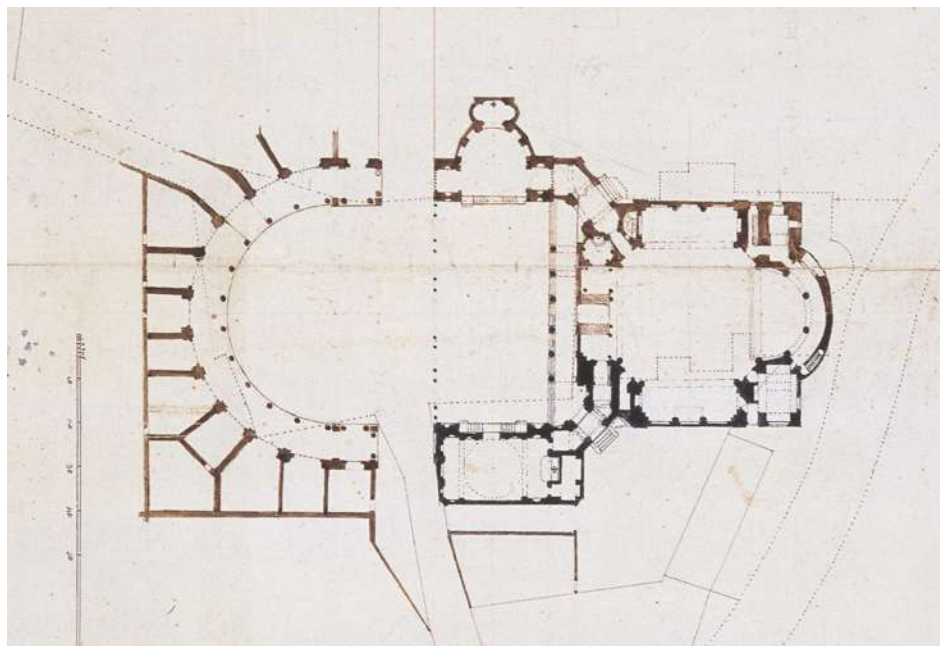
S. Cantoni, *Studio planimetrico della nuova chiesa e rilievo del mausoleo Serbelloni, 1805 ca
